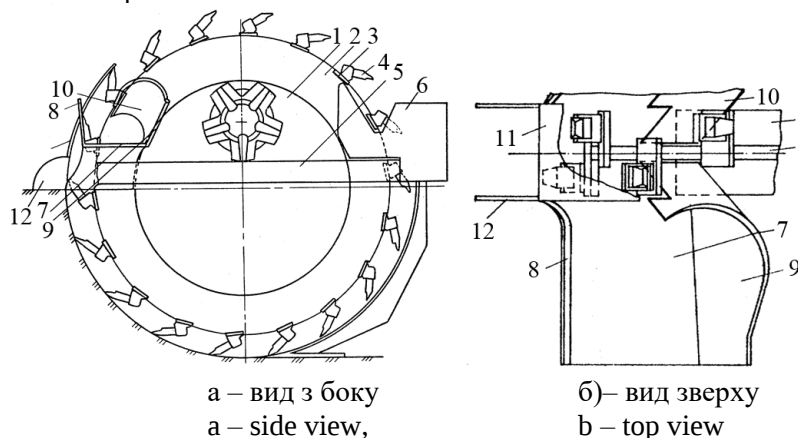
Робочий орган роторного екскаватора з двохступеневим розвантаженням: 1 – ротор; 2 – диск центральний; 3 – траверса; 4 – ґрунторозроблюючий різець; 5 – рама; 6 – бермоутворювач; 7 – основа лотка; 8 – стінка передня лотка; 9 – стінка задня лотка; 10 – ґрунтознімач; 11 – перемичка передня; 12 – щитки захисні
